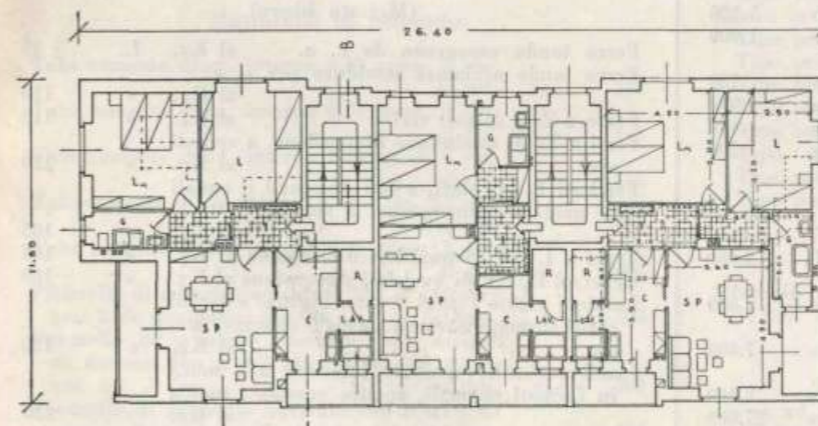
Pianta piano tipo: Motto "Ciòdin".
